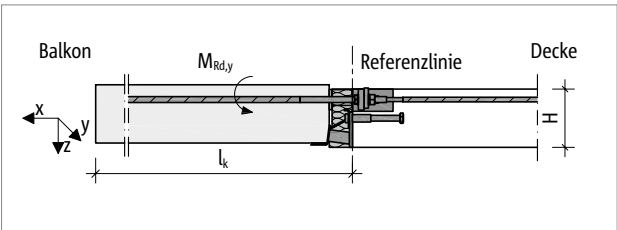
Schöck Isokorb® IQ Typ K-A: Statisches System
